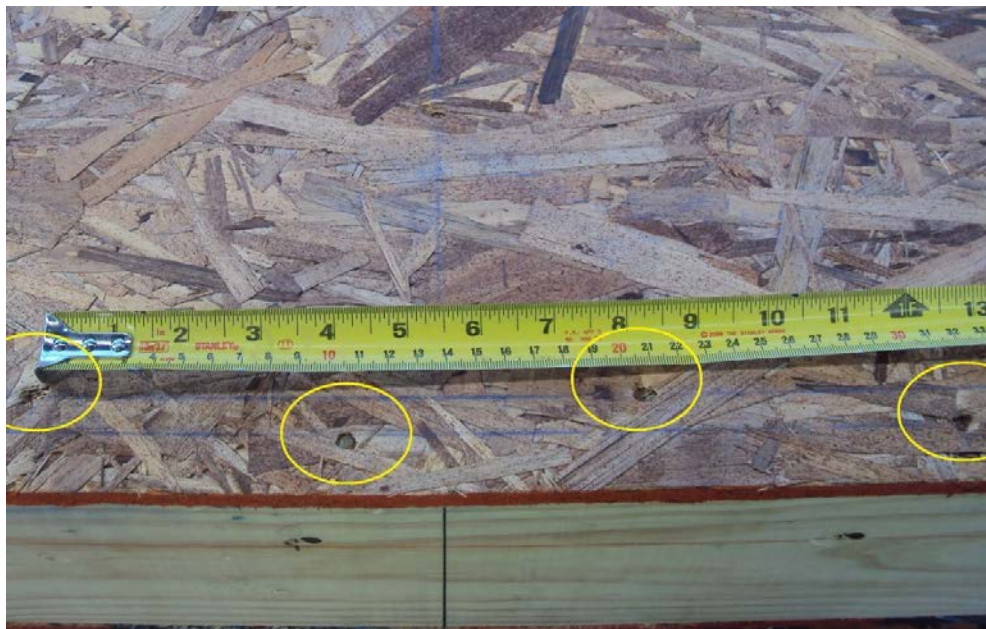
Muro Longitudinal con clavos escalonados cada 100mm.
